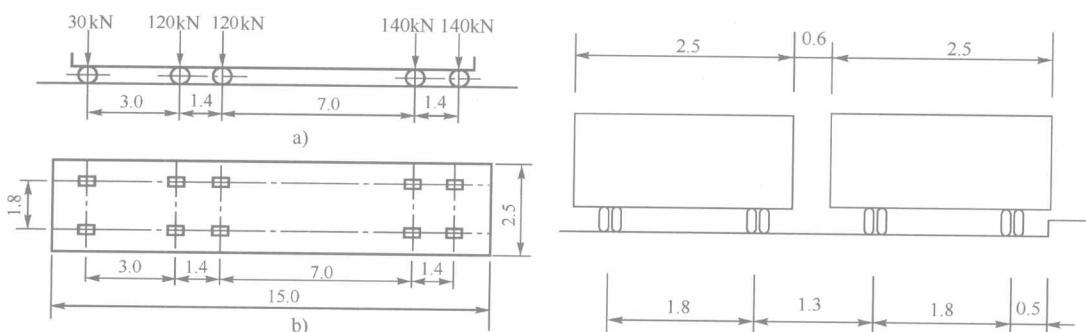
车辆荷载的立面、平面尺寸(尺寸单位:cm)
